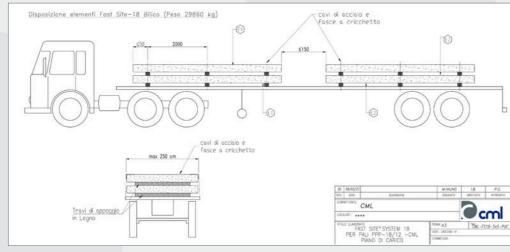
Piano di carico FAST SITE® SYSTEM 18
